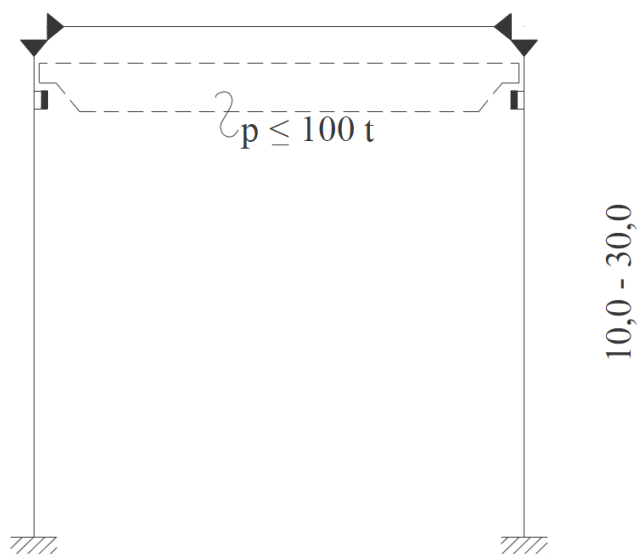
Schema capannone con pilastri incastrati alla base e collegamento rigido a flessione della traversa.
